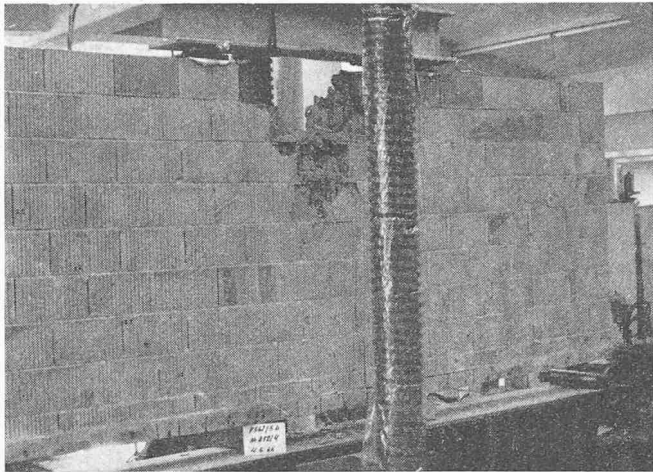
Mit Stahlton-Brett verstärkte Preton-Modellwand bei Bruchversuch (Photo: Prüf- und Forschungsstelle Luzern)
